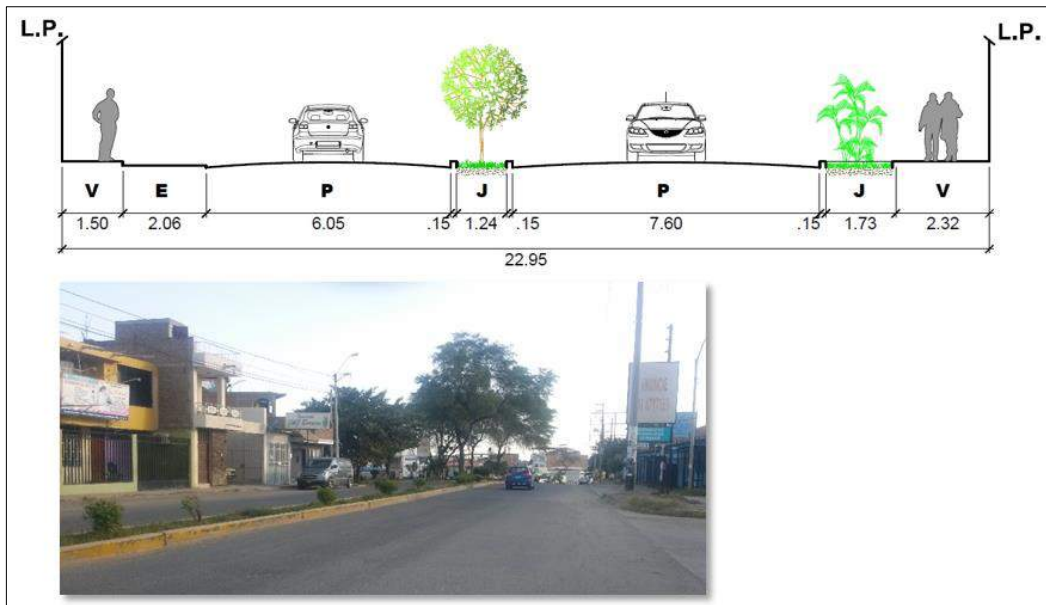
Sección Vial – Av. Santa Rosa (tramo 02)
